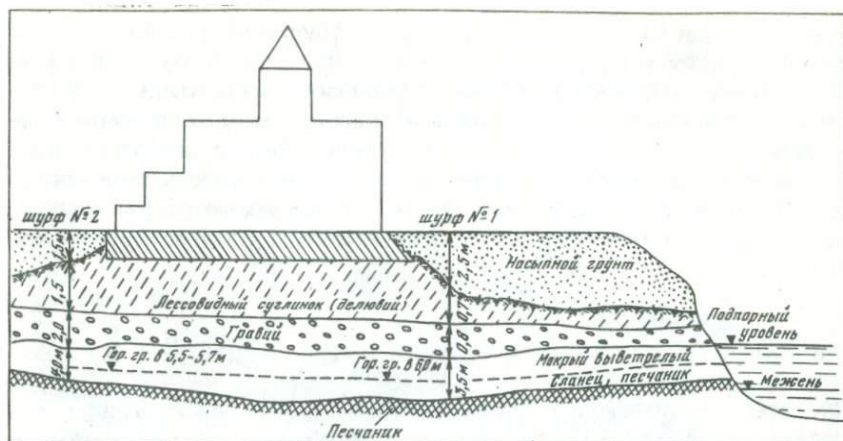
Грунтово-гидрогеологическая ситуация в основании фундамента храма Свети-Цховели (Мшвениерадзе, 1952)
